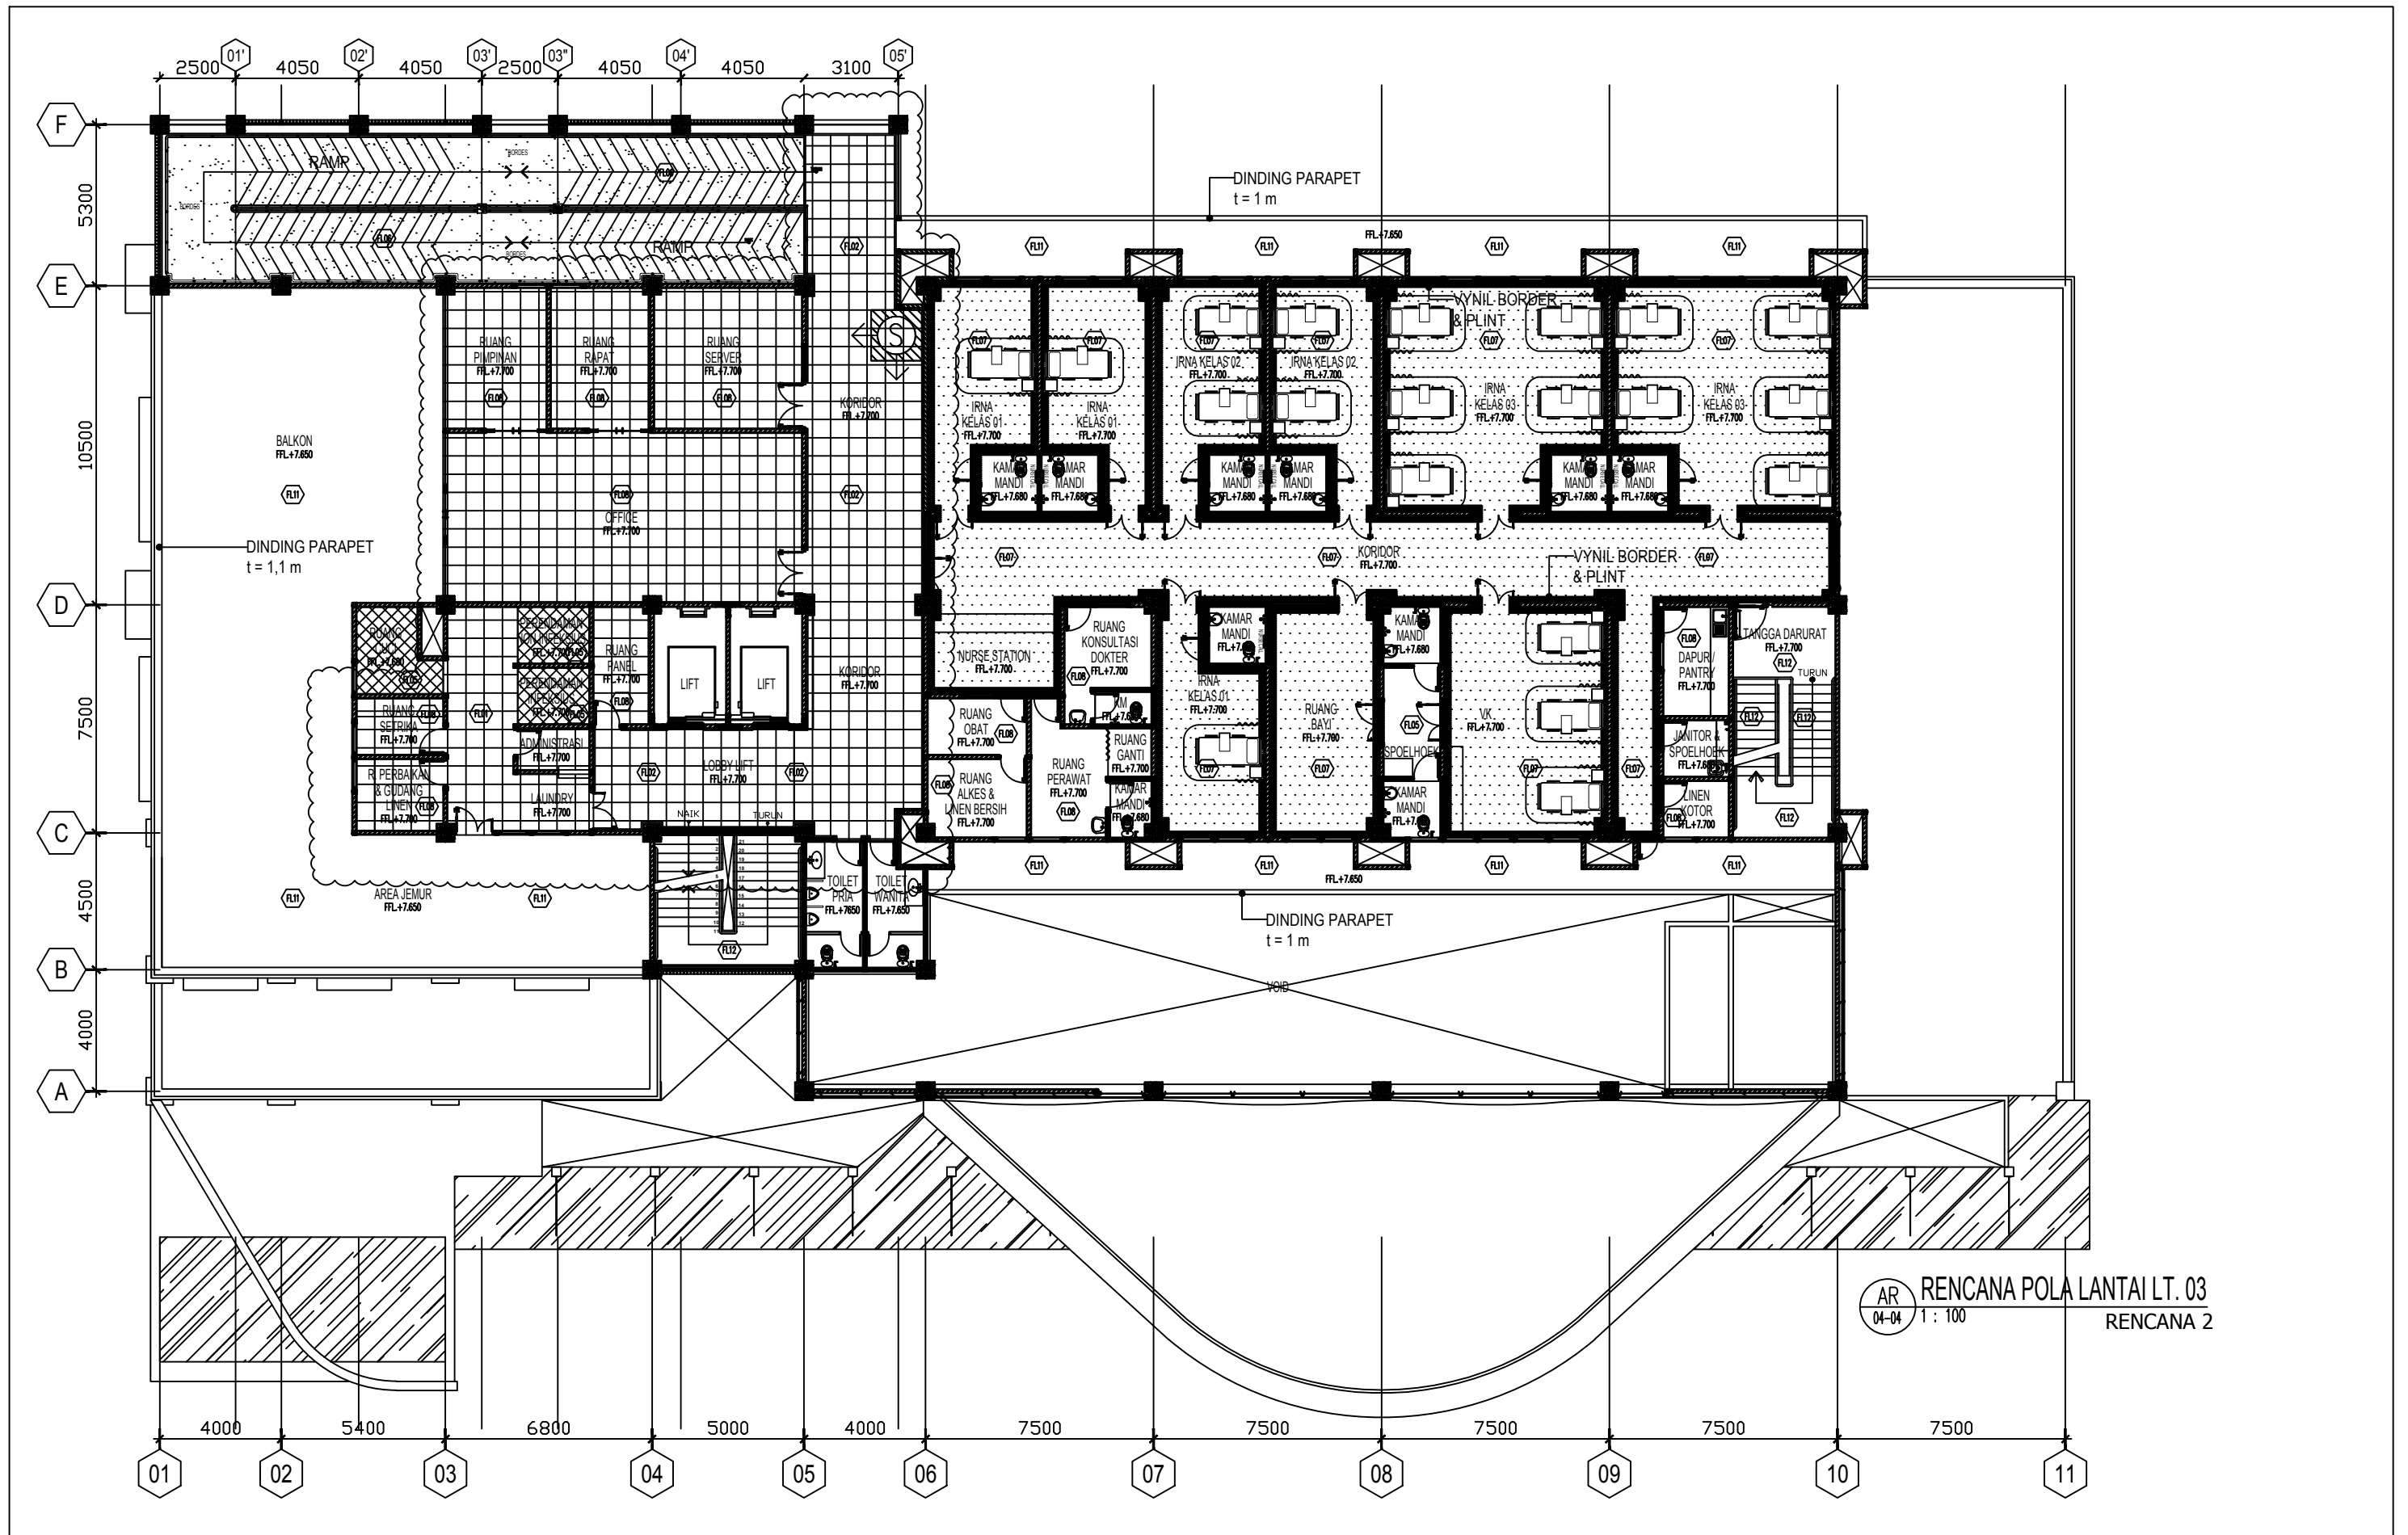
Denah Pola Keramik Lantai 3 (versi eksisting)
